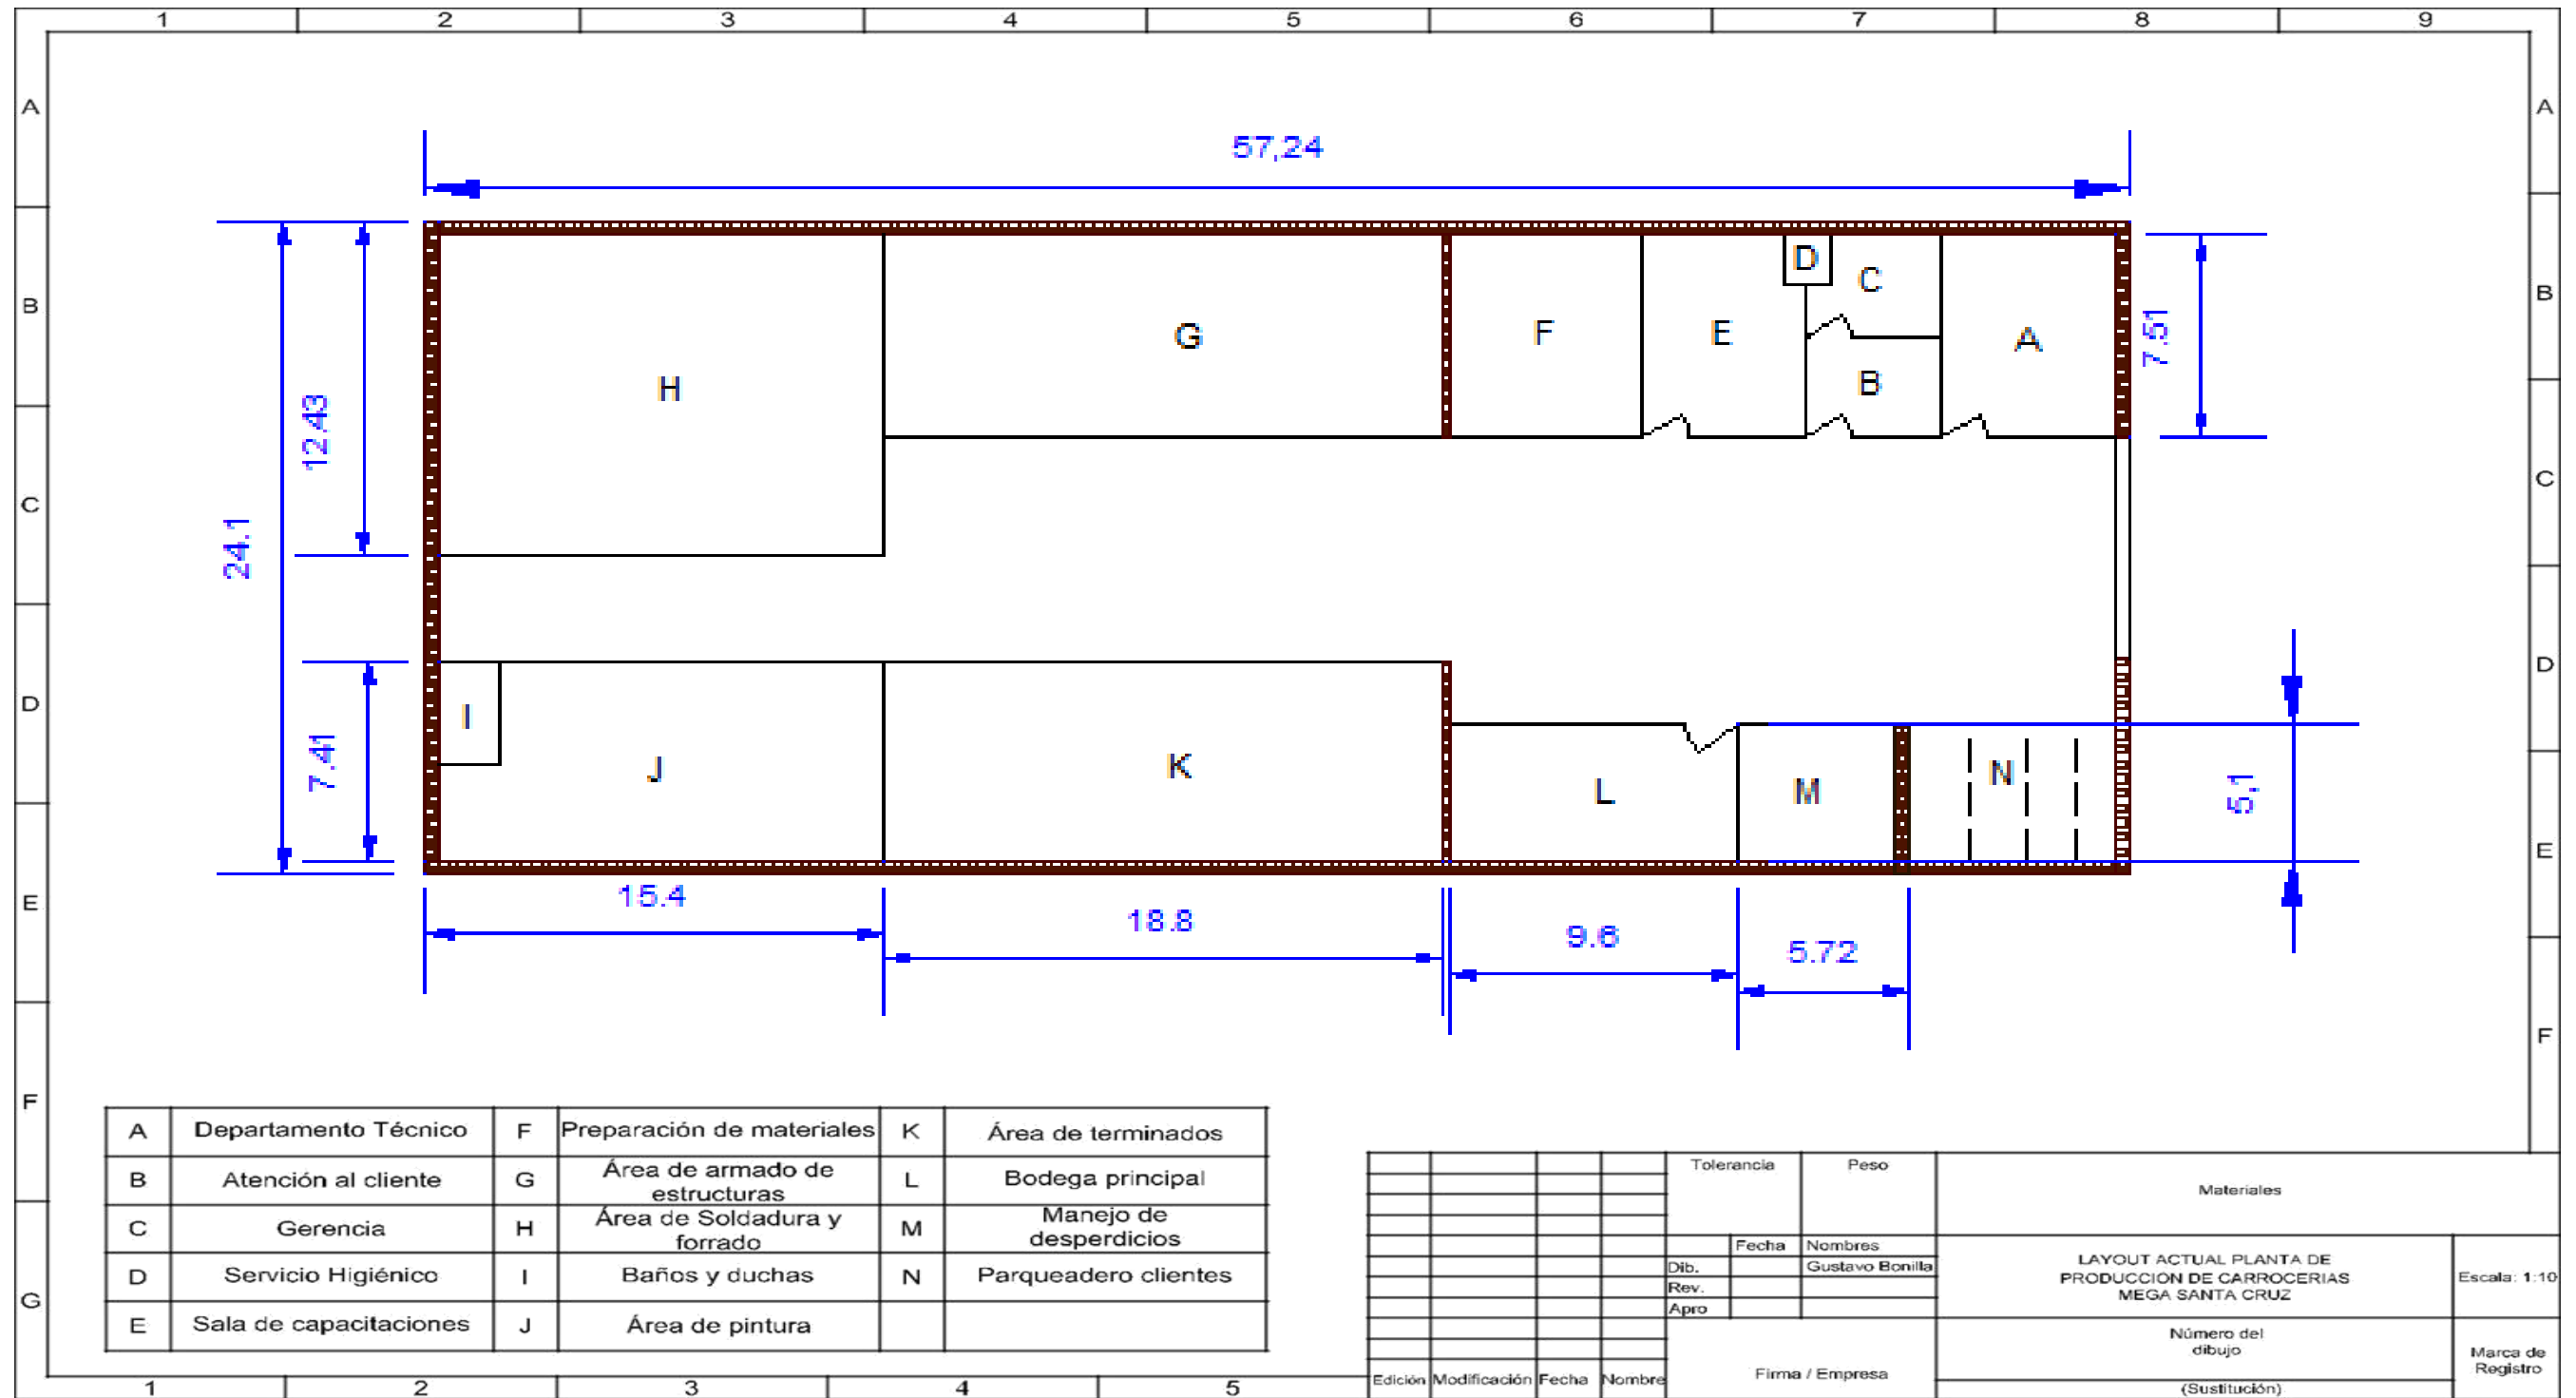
Layout de la planta de Carrocerías Mega Santa Cruz
